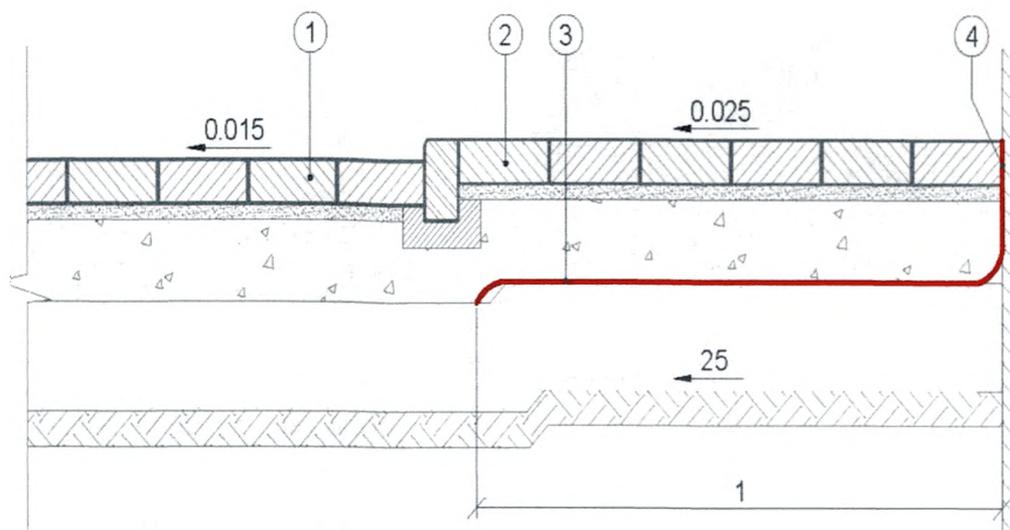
Гидроизоляция подземных частей зданий, к которым примыкает мощение
